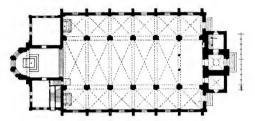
Grundrifs der Kirche zu Bremerhaven.
